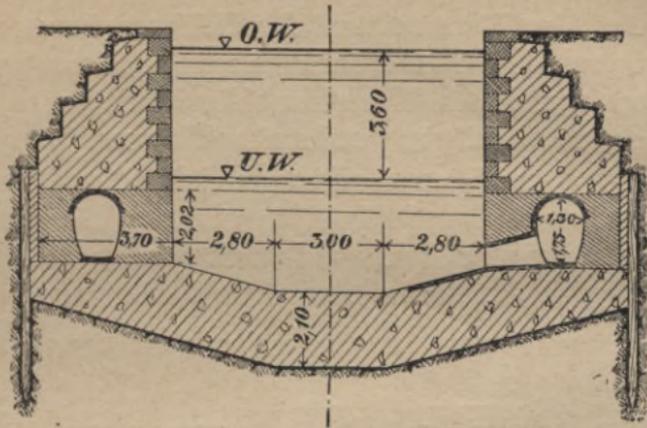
Querschnitt einer gemauerten Schleusenammer.
